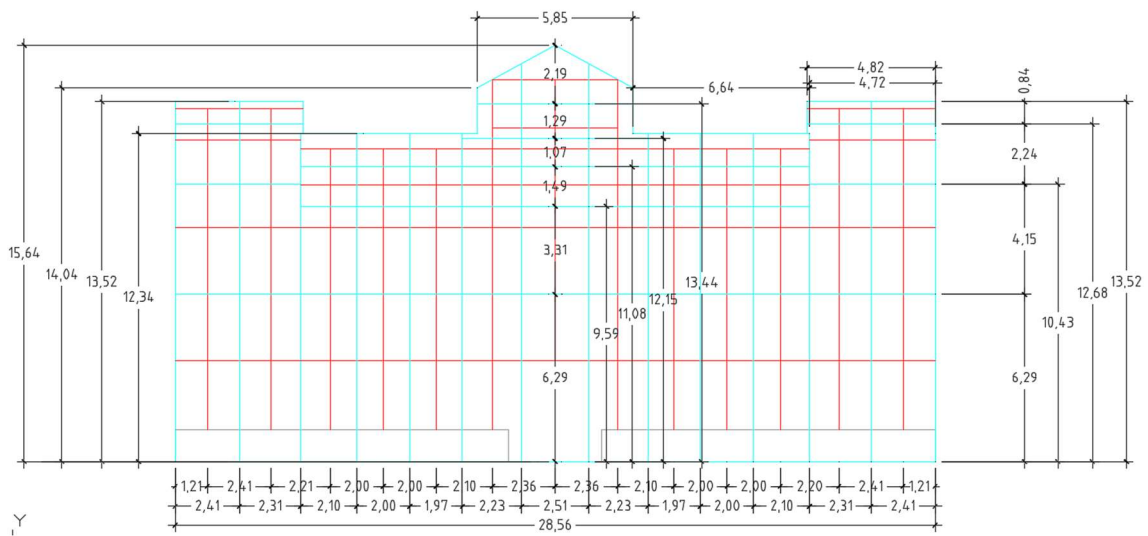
, Fachada principal con la estructura metálica acotada y sus zonas de acción
